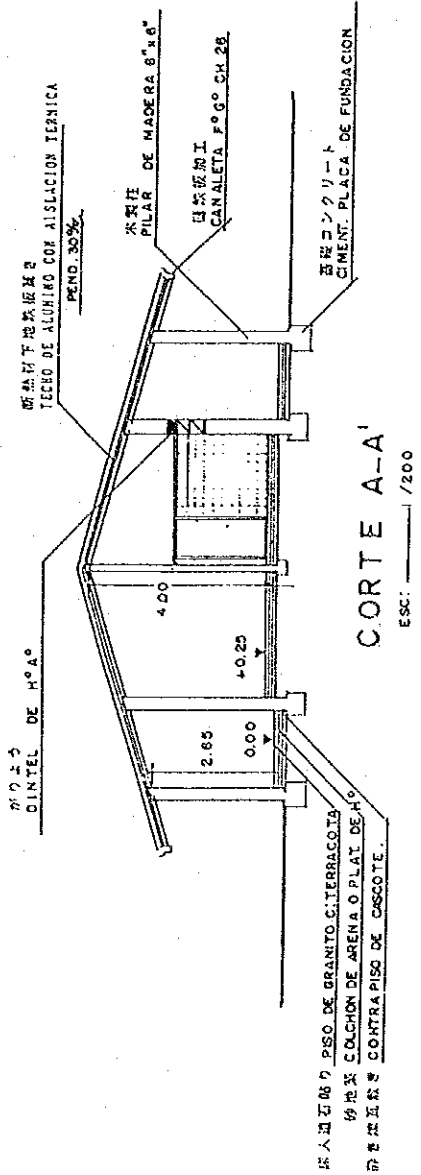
(S) 農業省研究センター 朝陽北新倉庫 立面図 断面図
